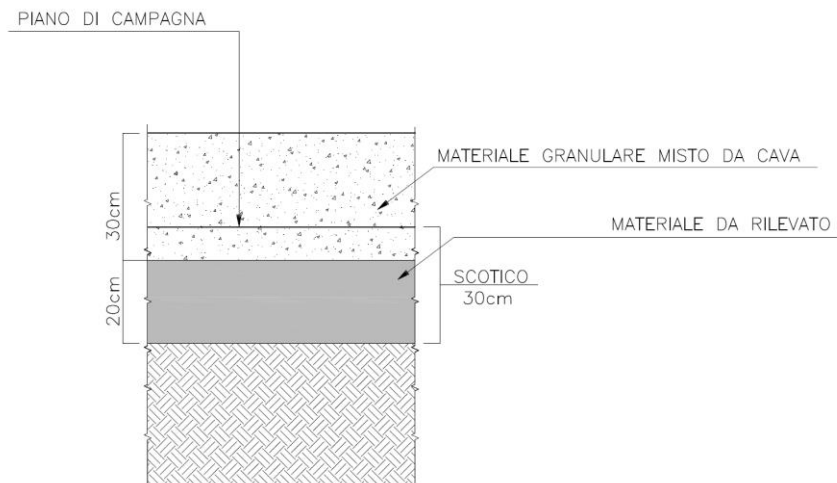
pacchetto di pavimentazione nell’area di stoccaggio
